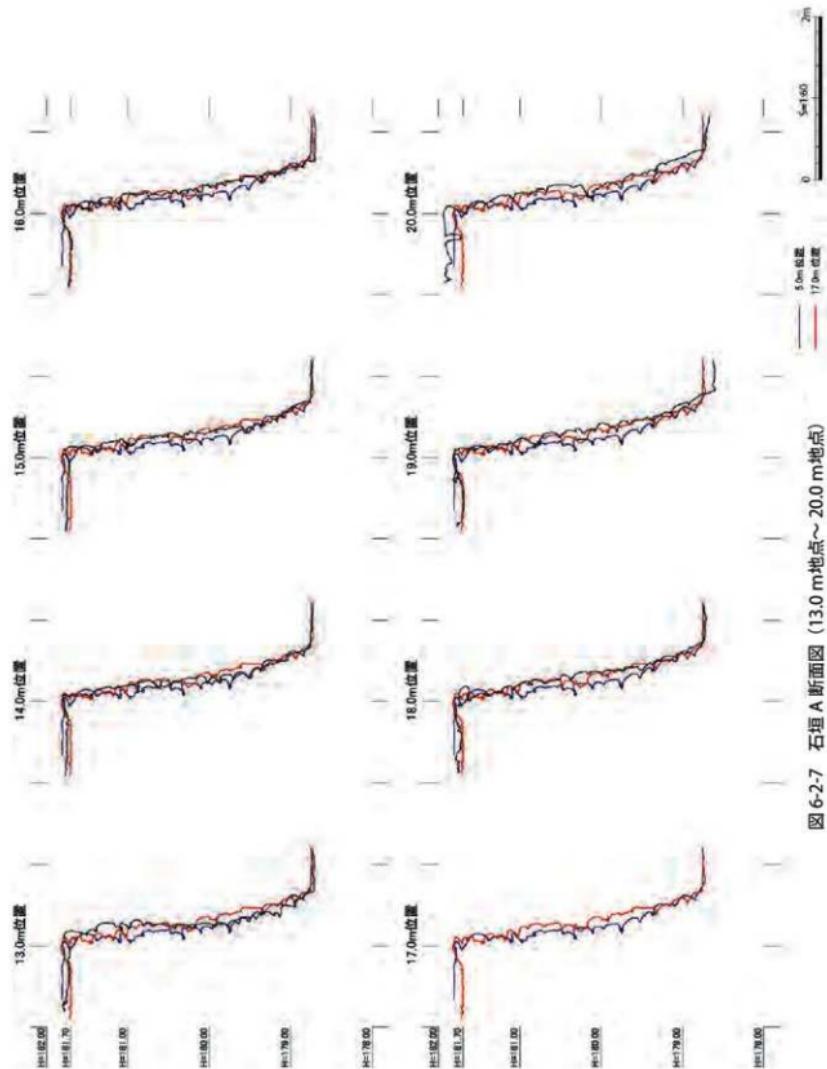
石垣 A 断面图 (13.0 m 地点~20.0 m 地点)
